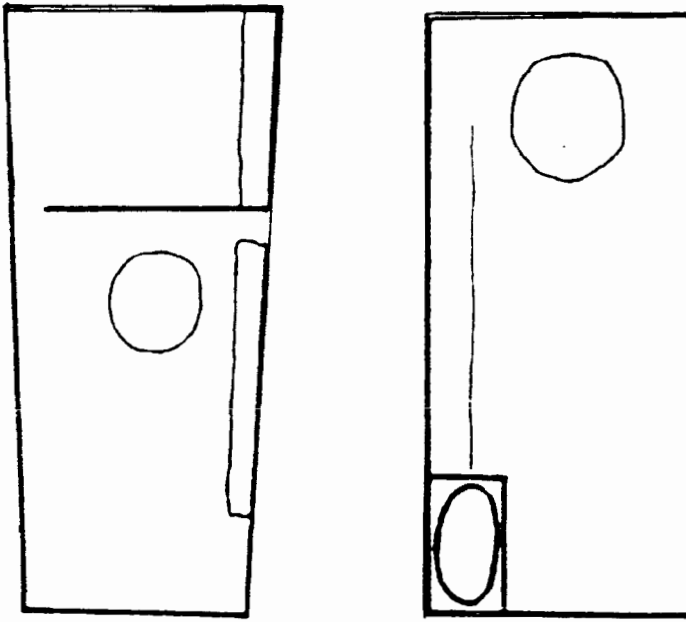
Esquema en planta de dos casas de Zaforas.
